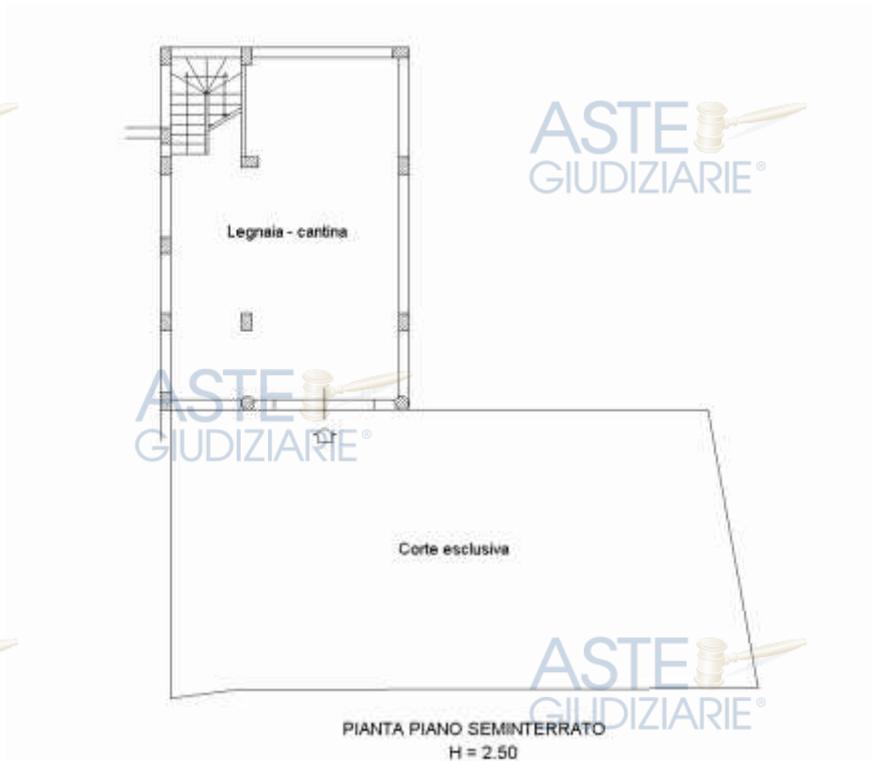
Planimetria Catastale – Piano Seminterrato
